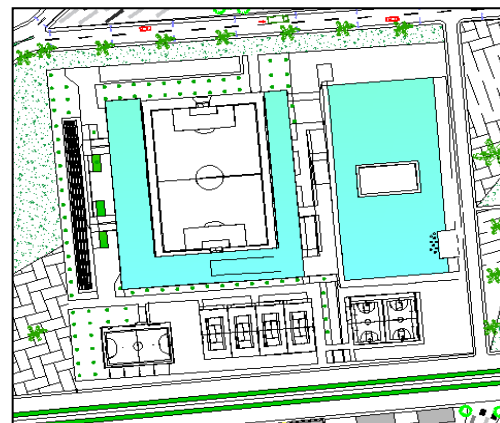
Vue en plan d'un complexe sportif après l'intervention
